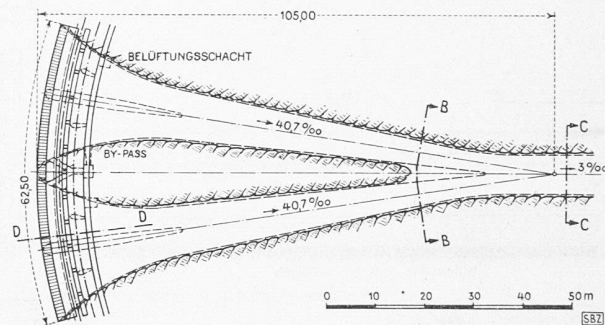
Wasserfassung, Grundriss 1:1500
